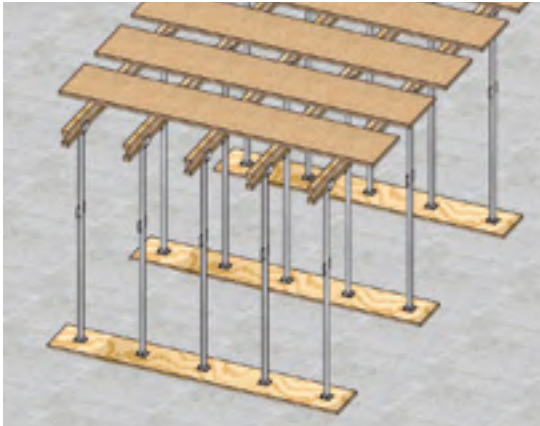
Pose et mise à niveau des planches ou bastaings
